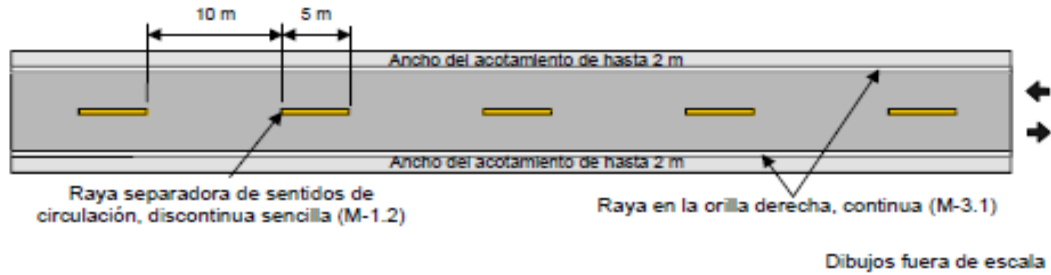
Marcas en el pavimento en carreteras con ancho de arroyo vial de hasta 6,5 m
